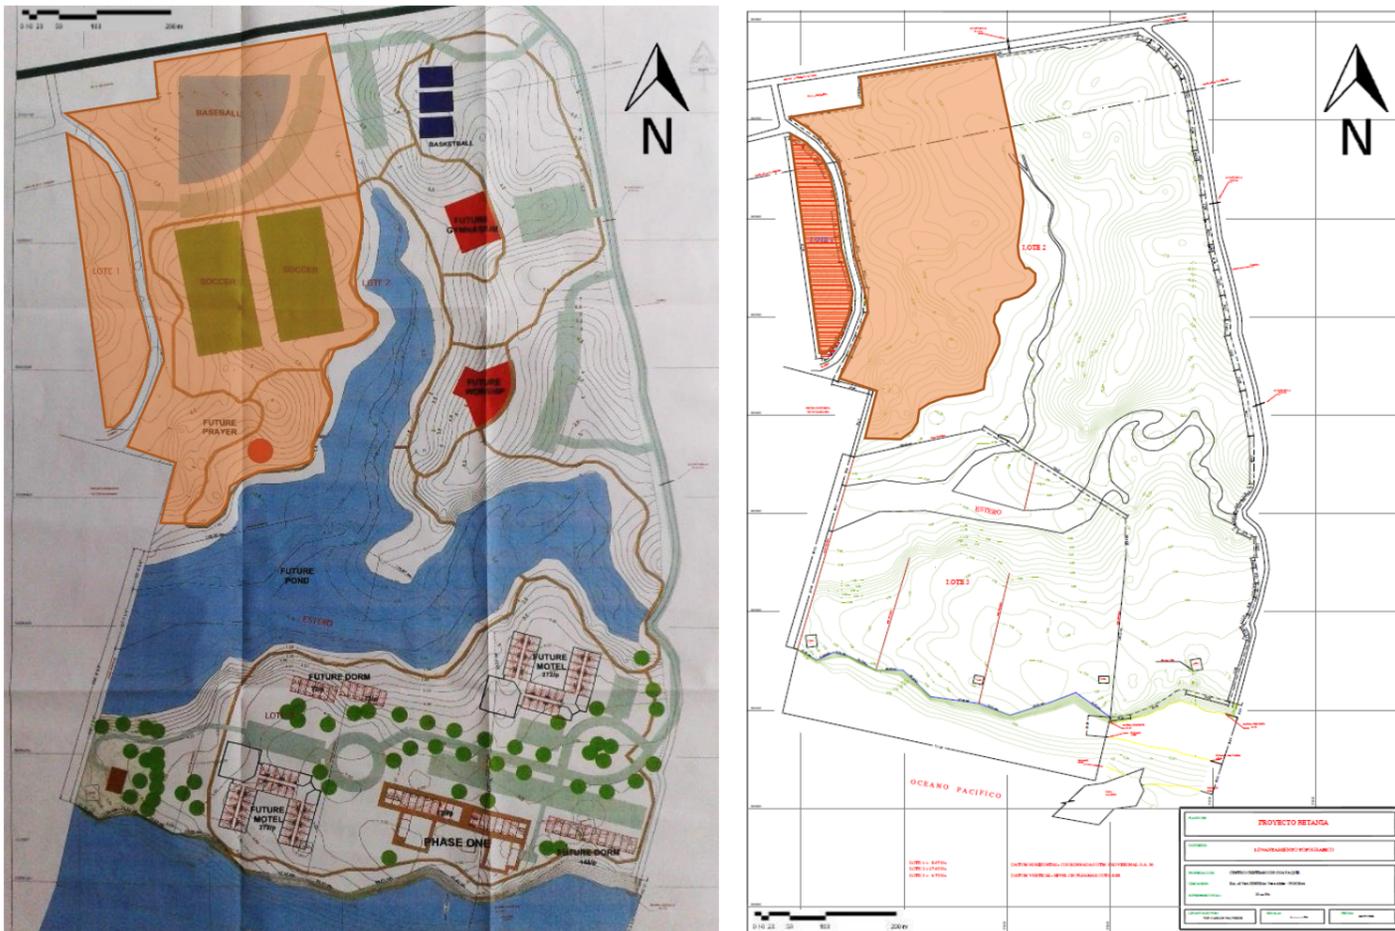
Fotografía del plano de implantación y plano del levantamiento topográfico del proyecto Betania.
